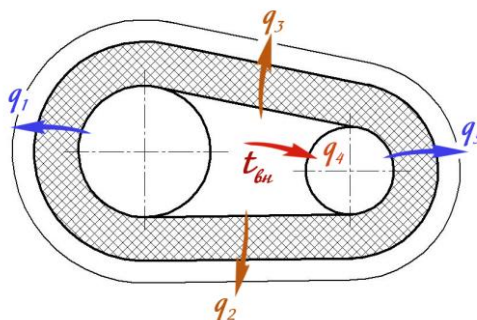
Схема тепловых потоков при совместной прокладке трубопроводов.
